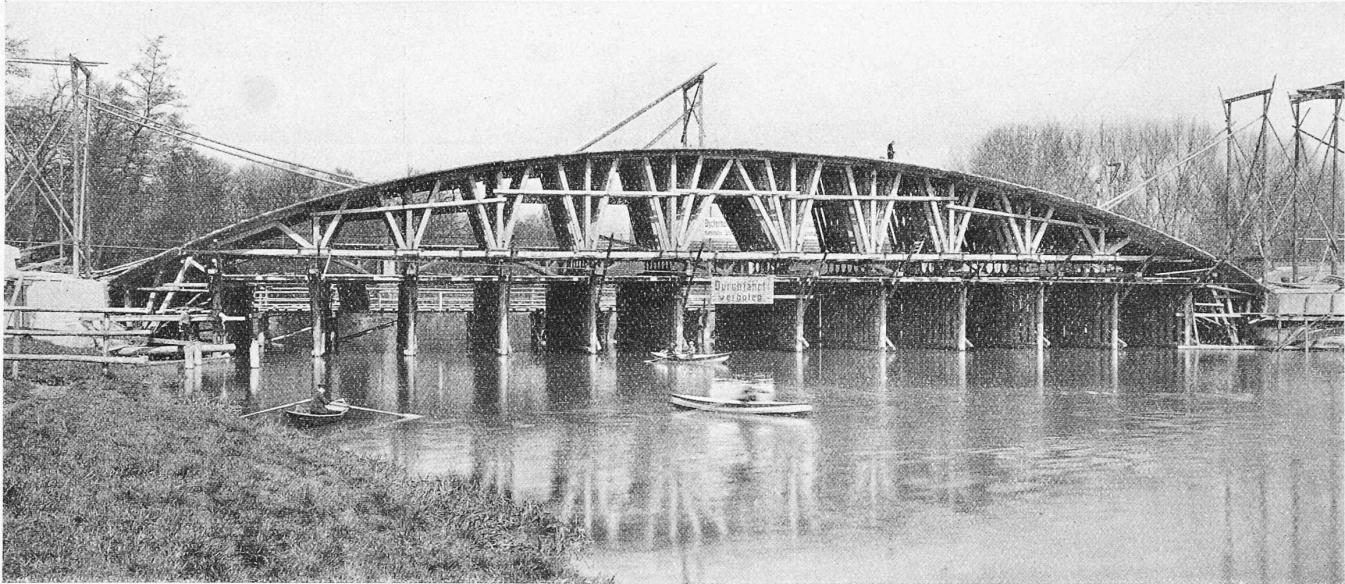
Lehrgerüst des Hauptgewölbes über der Flussöffnung, südliche Lage (16. IV. 1913).
